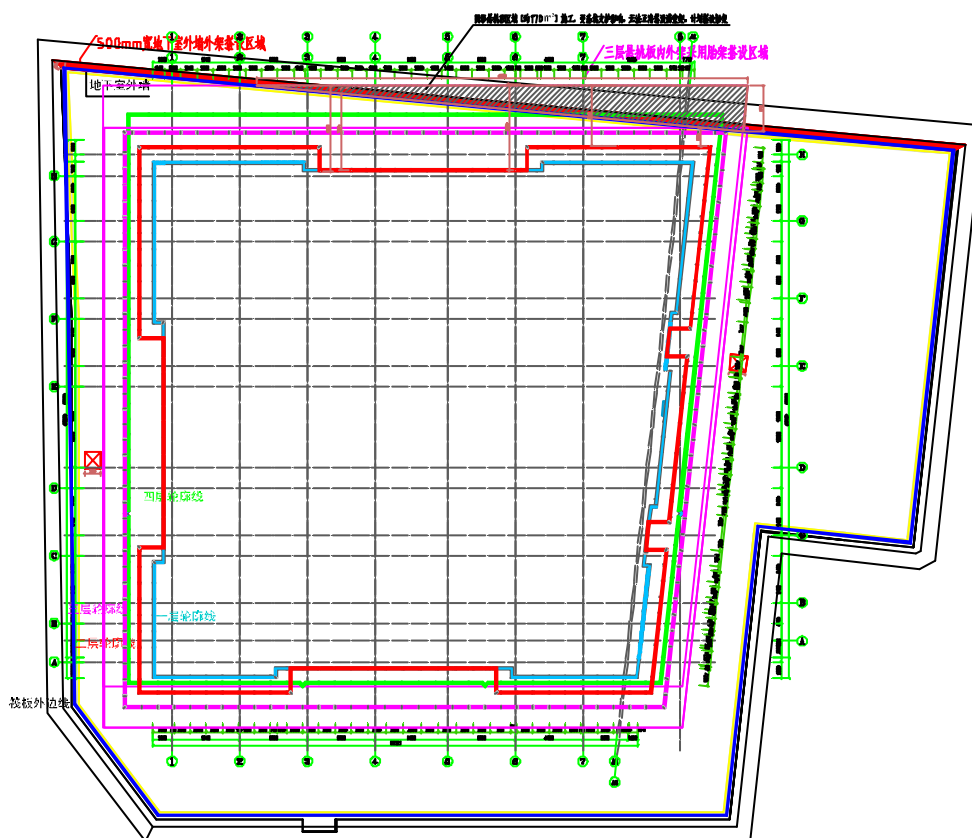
落地式双排脚手架搭设平面区域划分
